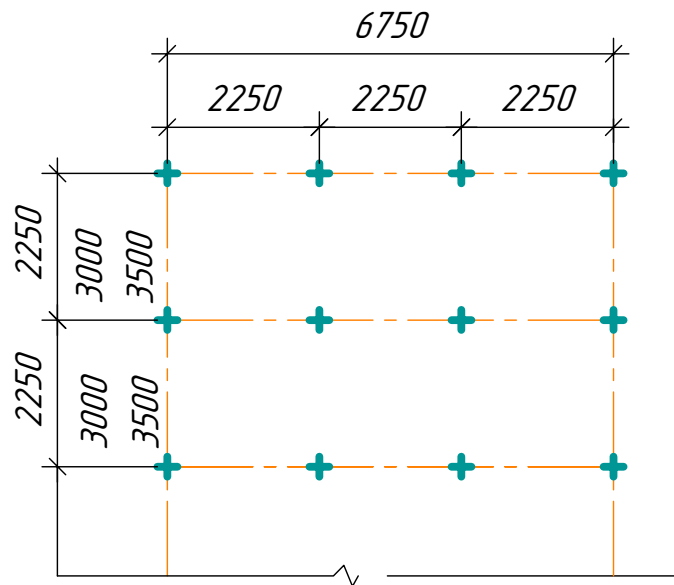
Схема плана свайного поля (точное расположение свай определяется расчетом)
